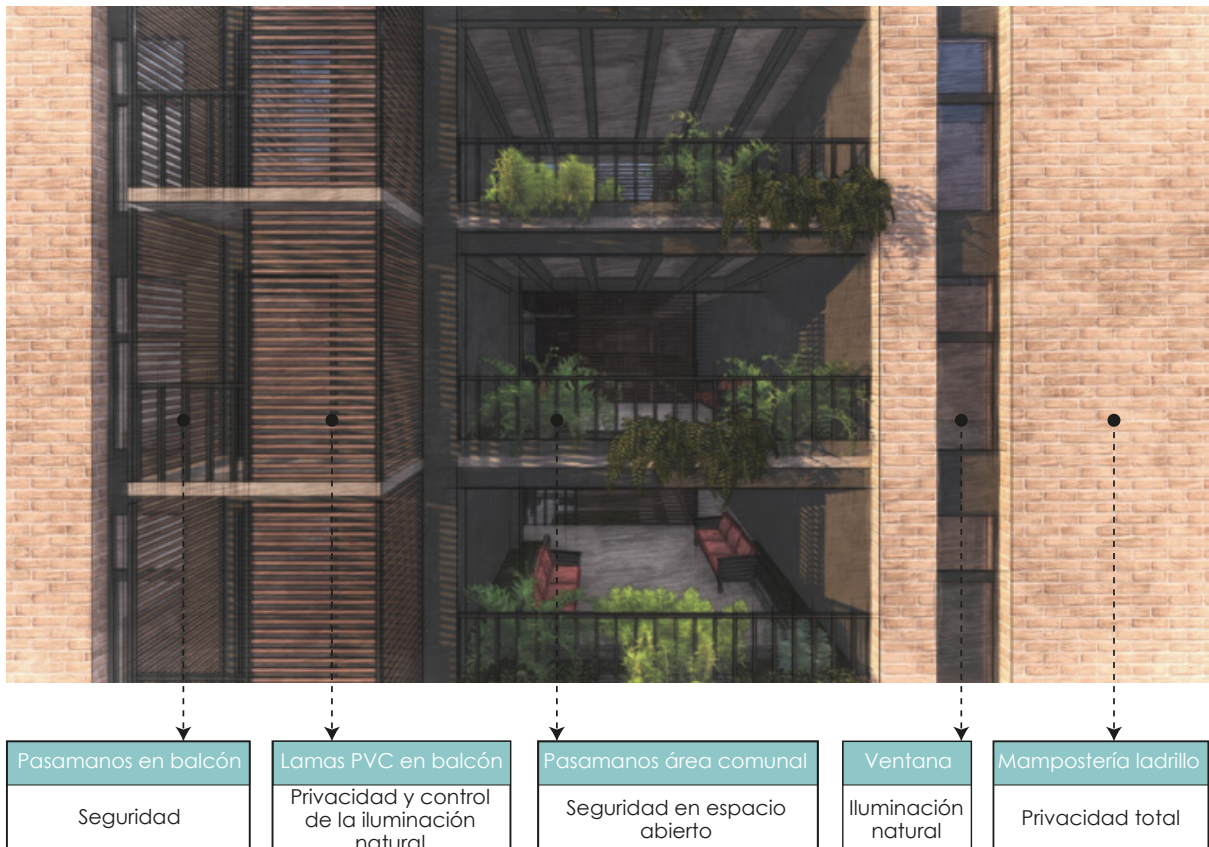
Elementos arquitectónicos usados en las fachadas
